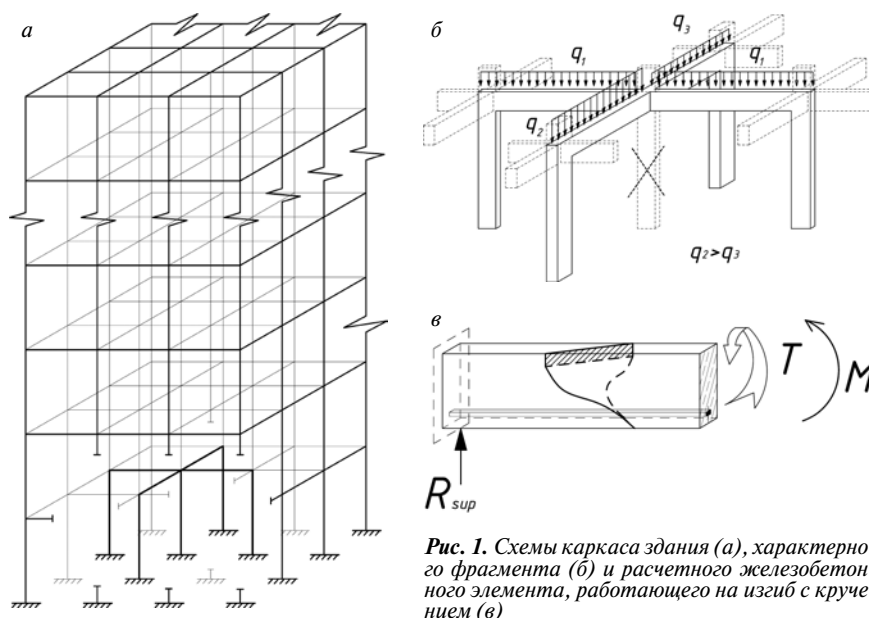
Схемы каркаса здания (а), характерного фрагмента (б) и расчетного железобетонного элемента, работающего на изгиб с кручением (в)
